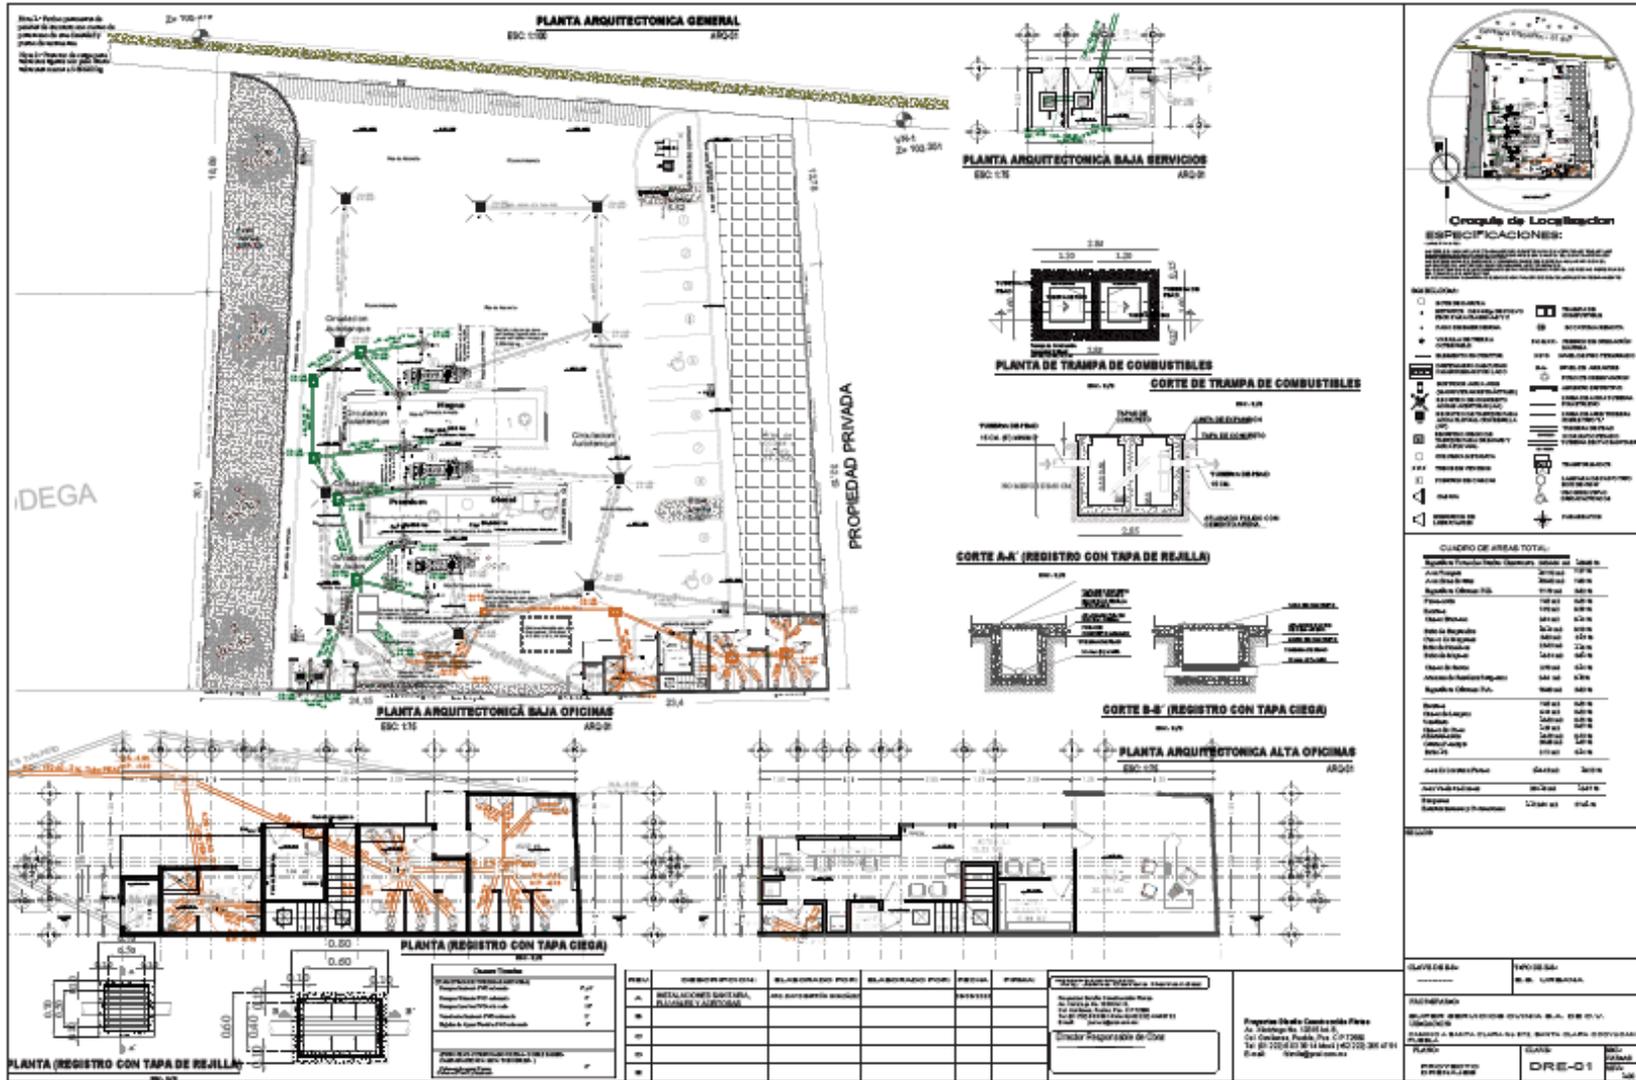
plano arquitectónico DRE-01 Instalaciones Sanitaria, Pluviales Y Aceitosas
